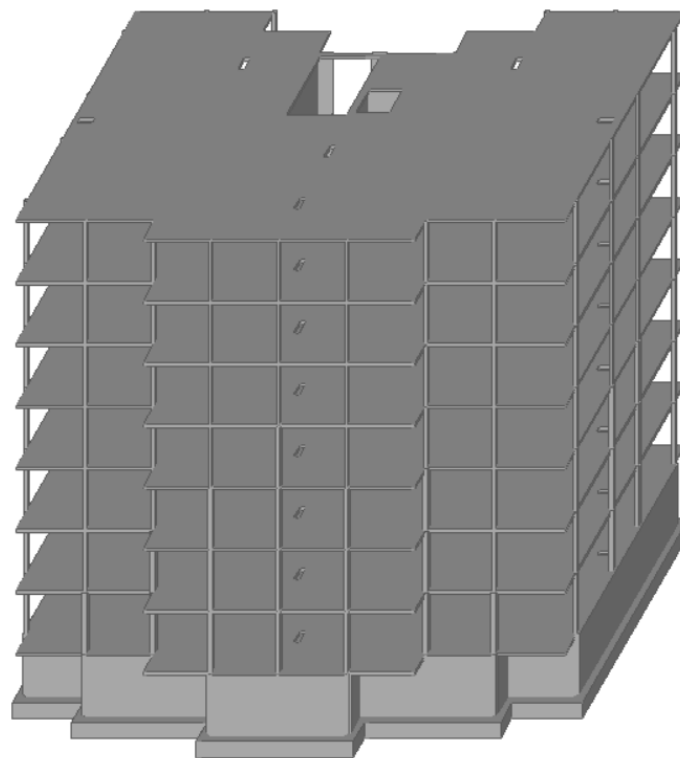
Розрахункова схема будівлі 3D вигляд
